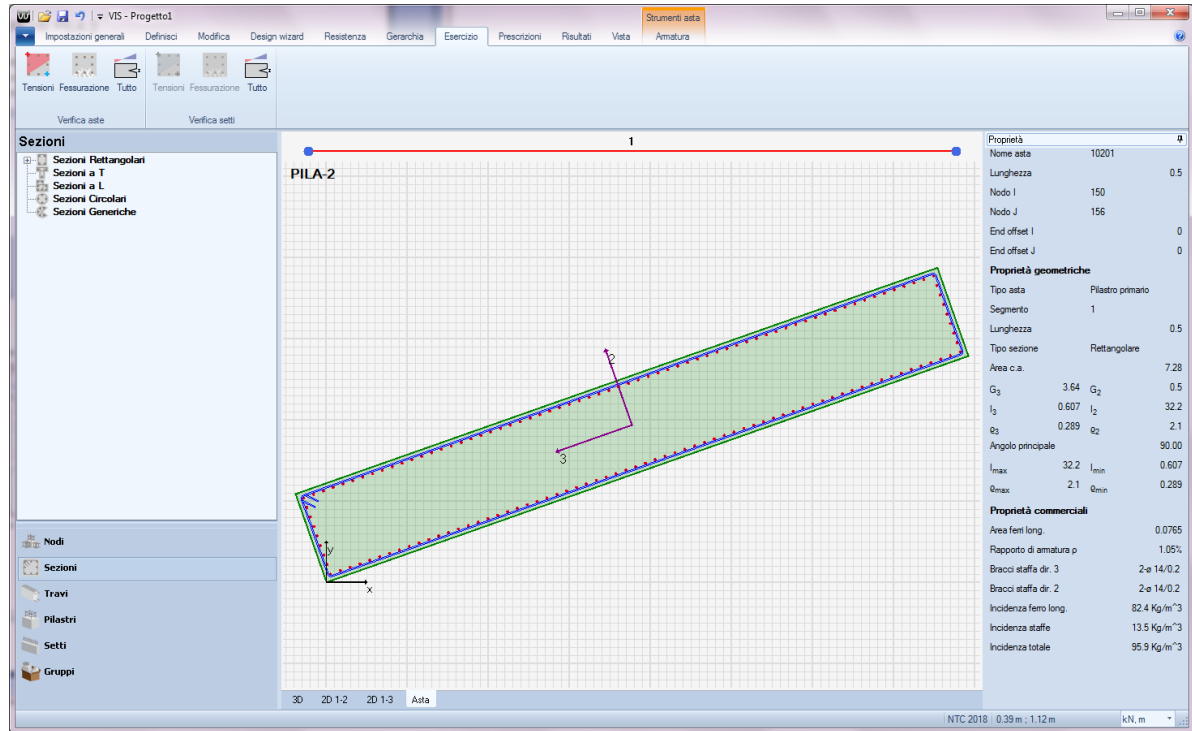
Pila 2: sezione di verifica 7.285 x 1.00 – ϕ 26/10
